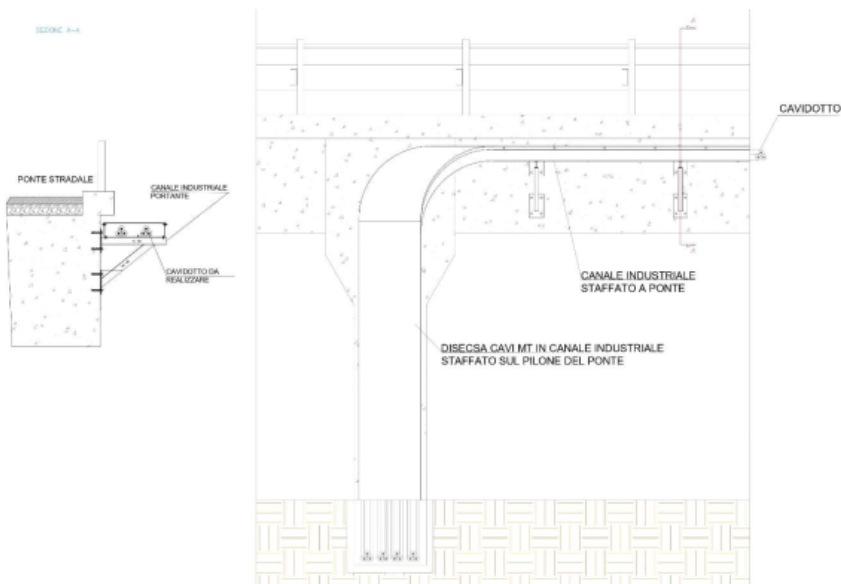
| Interferenza di tipo 4 staffaggio su ponte stradale – cavidotto posato in mensola staffata all'opera esistente con dettaglio sezione AA'
